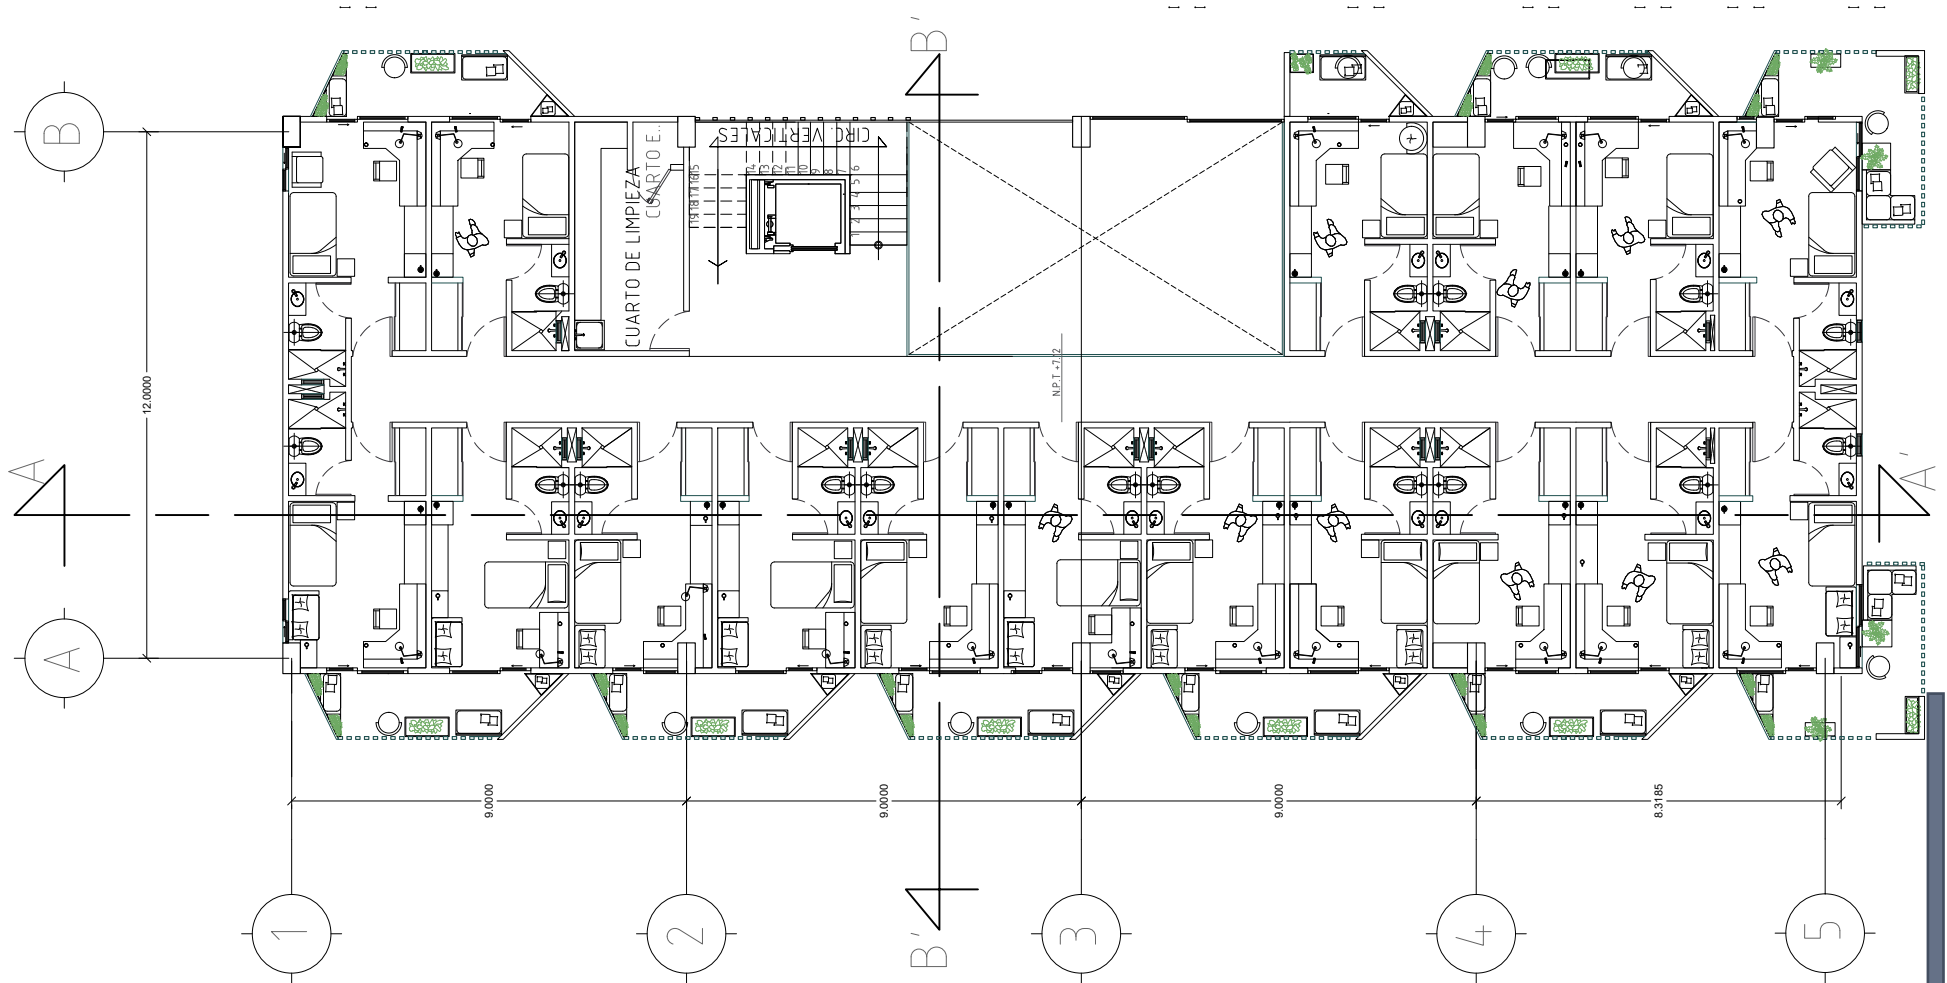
Planta tipo, definitiva elaboración propia 2022
